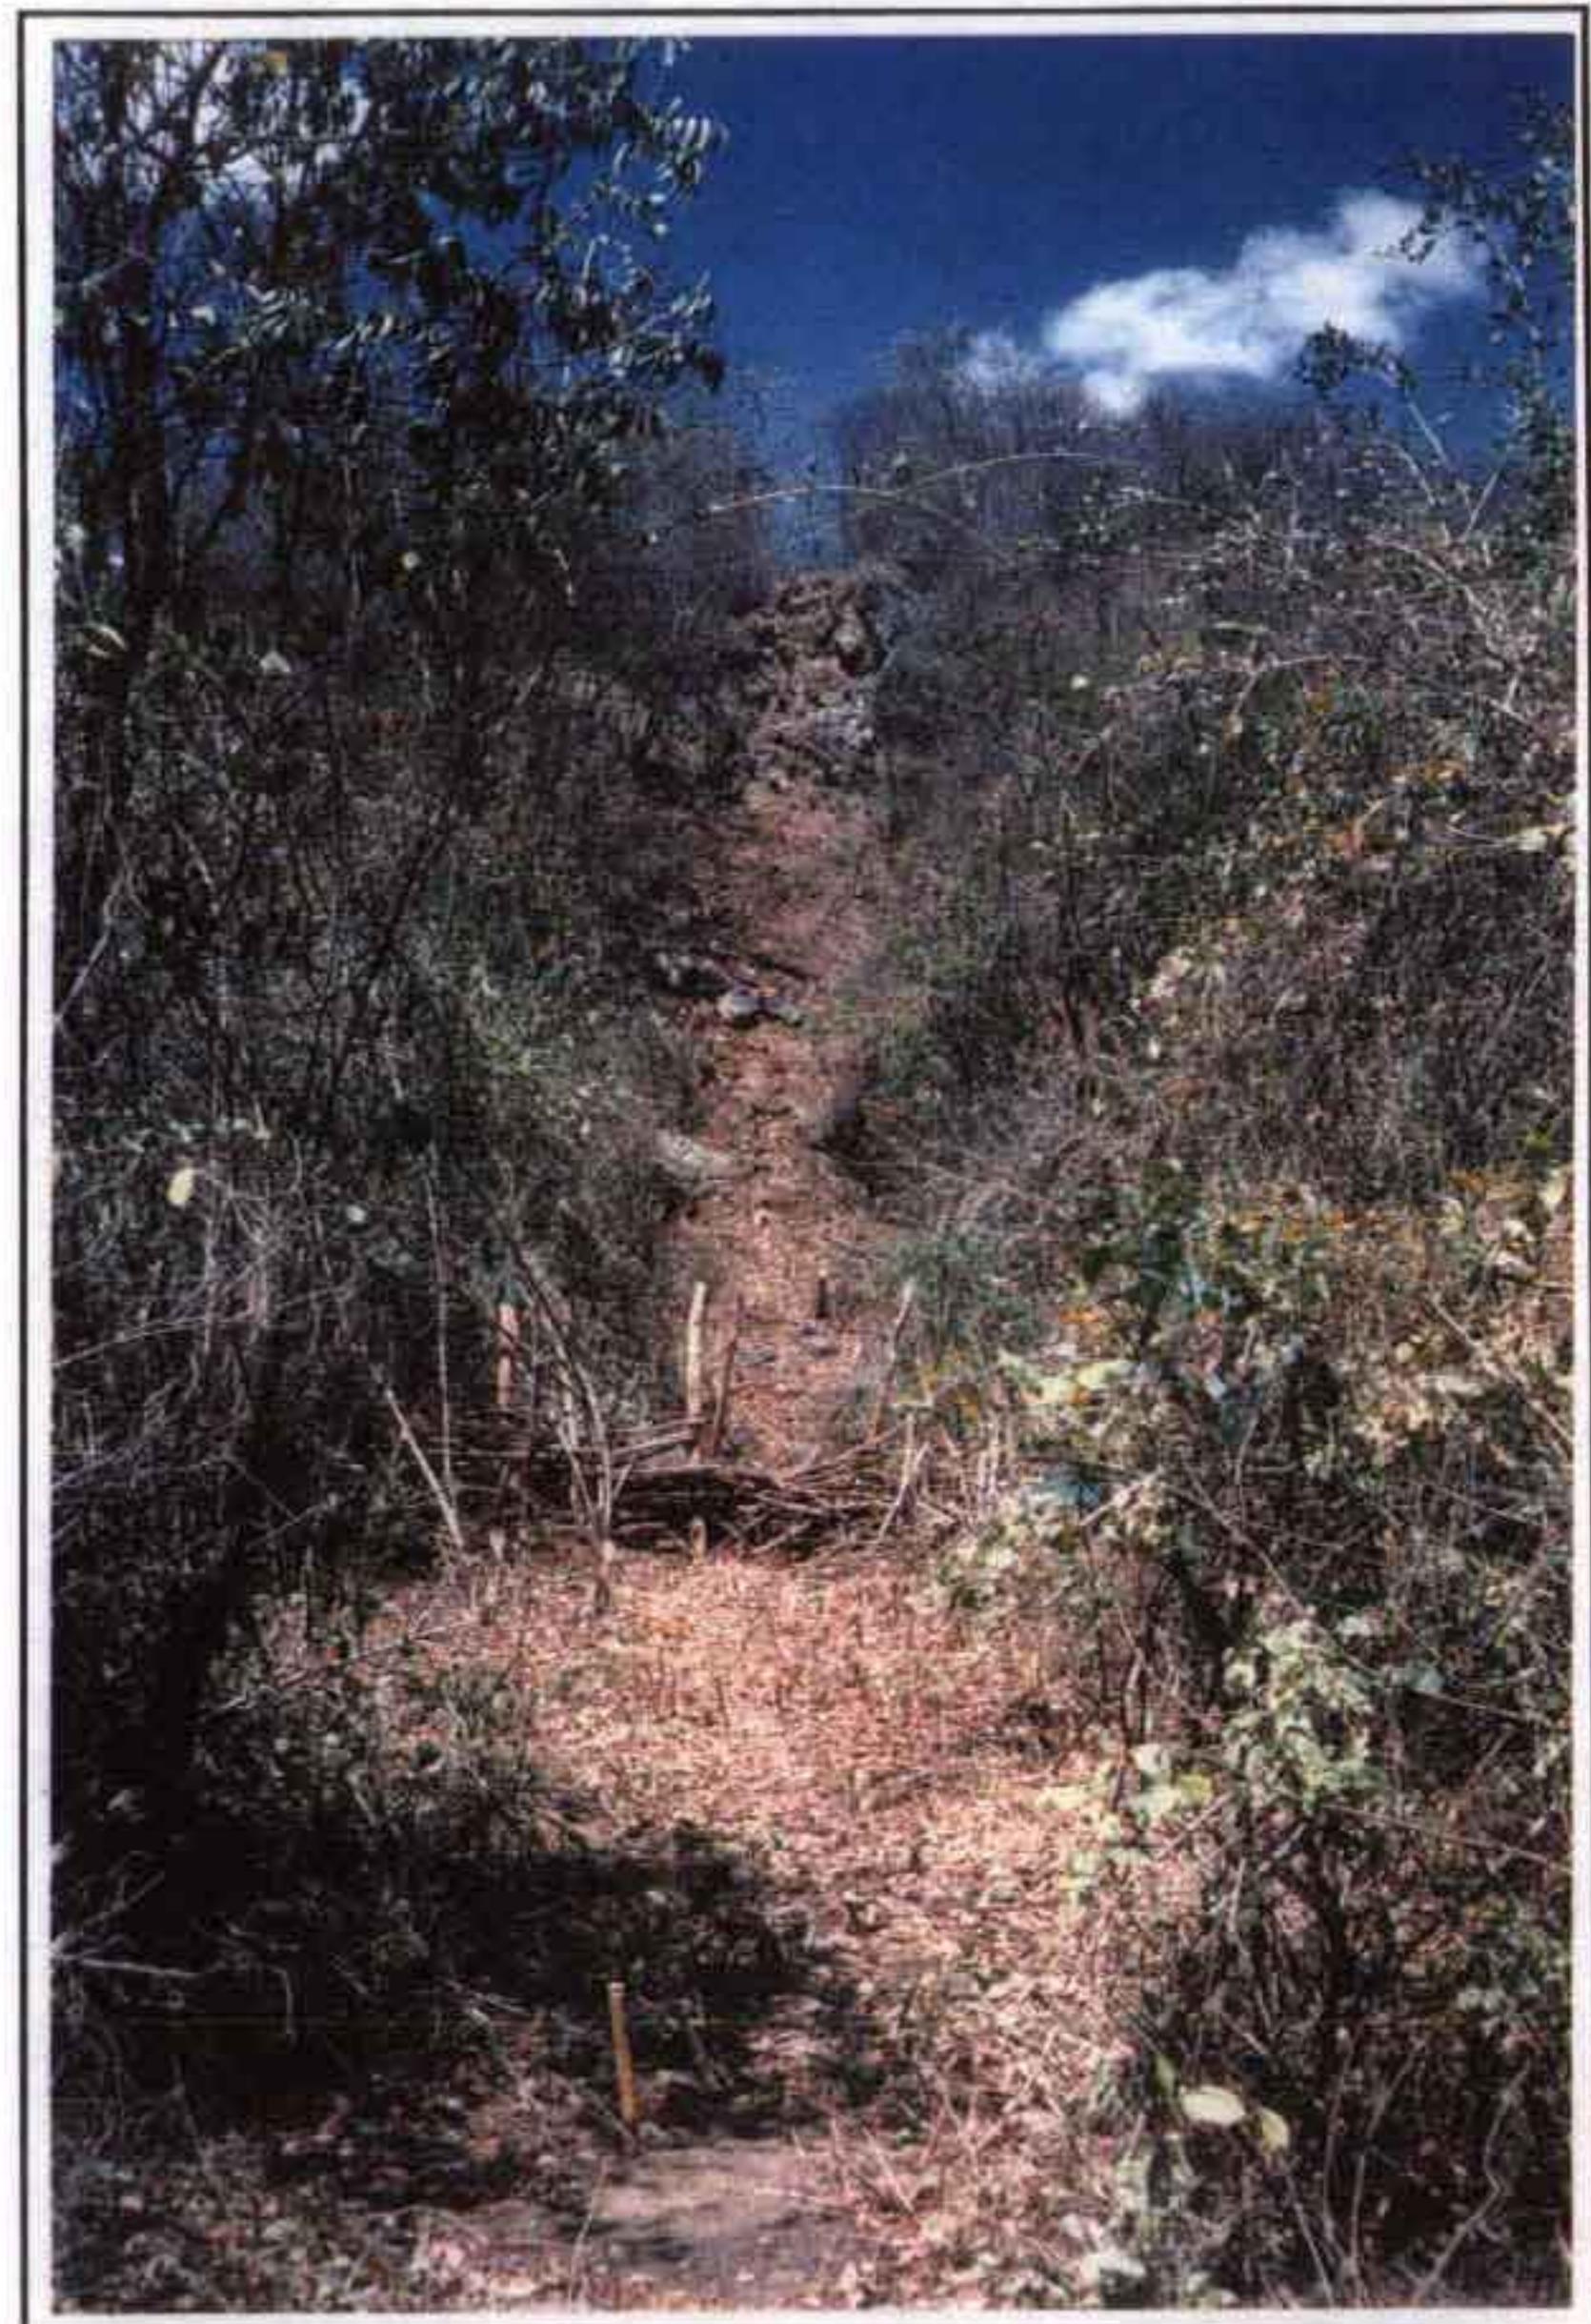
Detalhe da ombreira direita no trecho onde passa o eixo da barragem.
